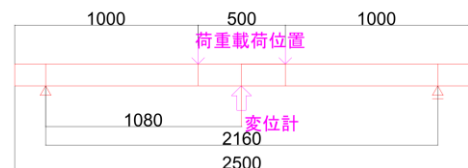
曲げ試験の荷重載荷位置および変位計設置位置 (寸法単位:mm)
